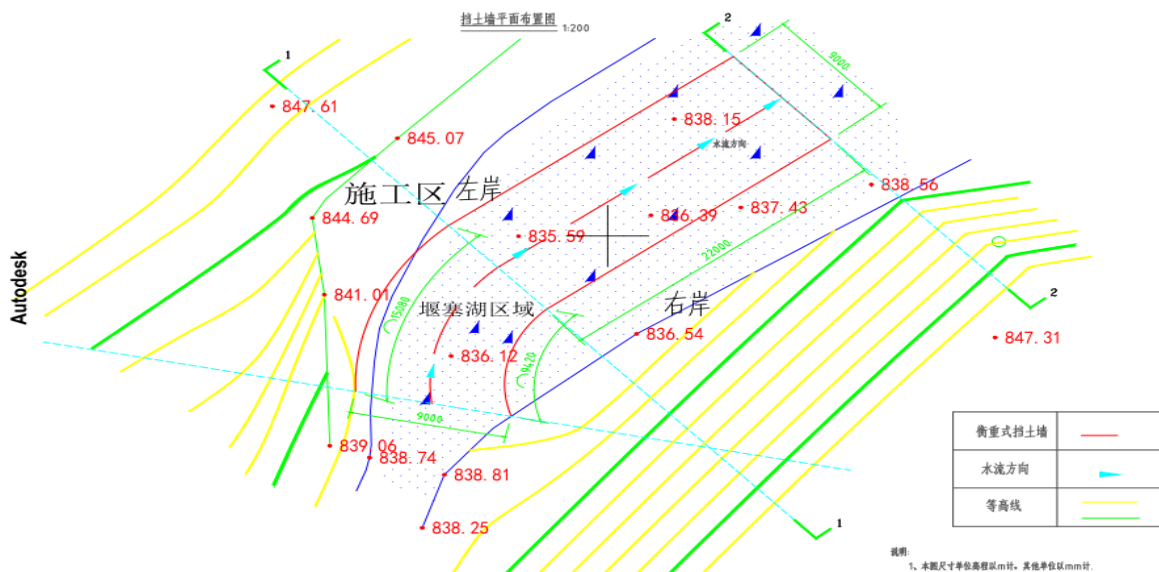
堰塞湖治理工程衡重式挡土墙平面布置示意图
